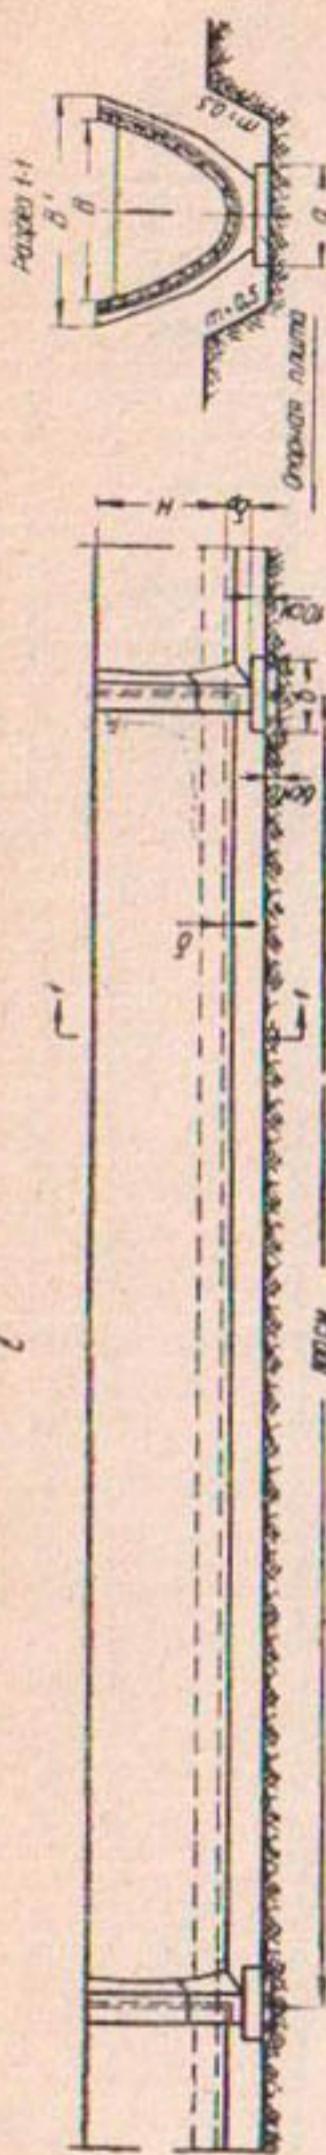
Конструкции железобетонных лотков параболического сечения (продолжение):
